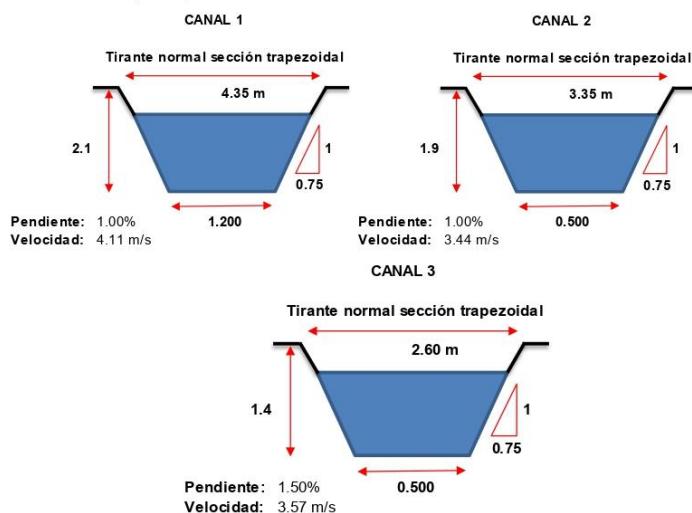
Secciones transversales de los canales de geometría trapezoidal
